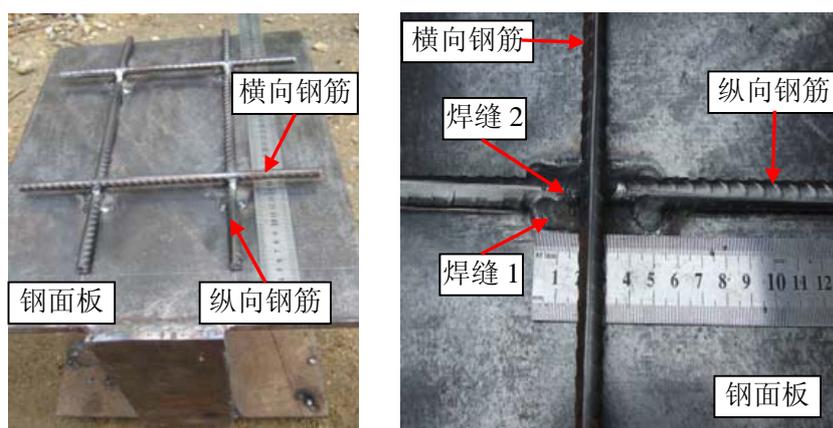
焊接水平钢筋网剪力连接件构造示意
